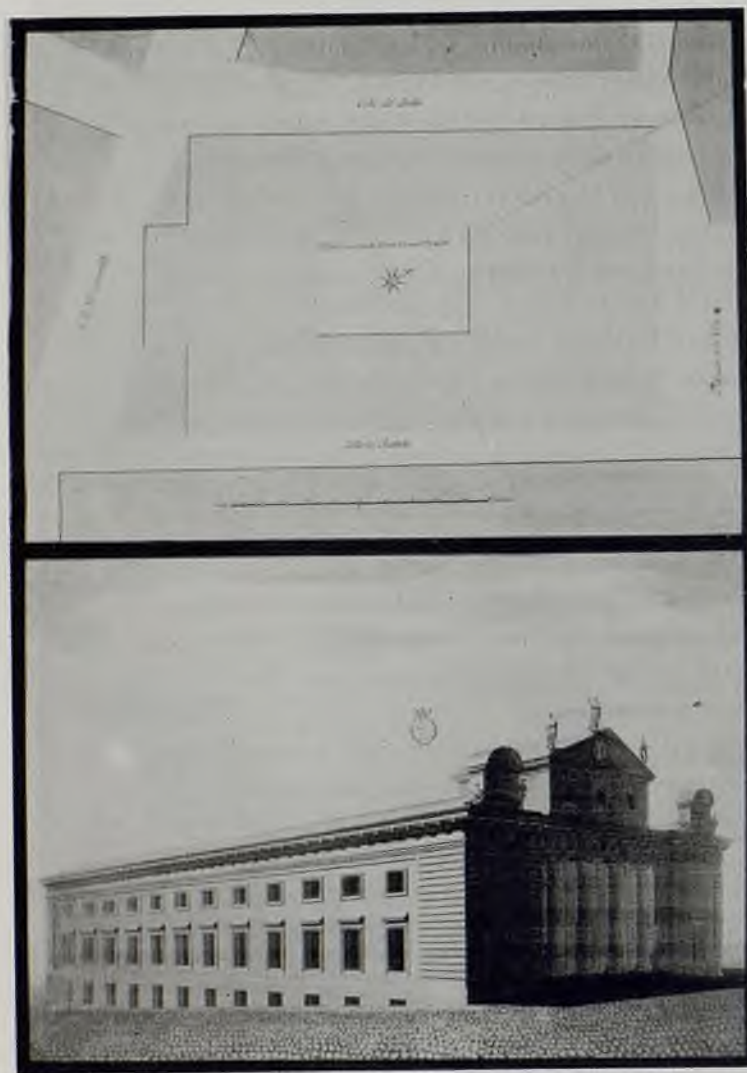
Fermín Pilar Díez, *Planta y alzado del proyecto para una Sala de Audiencia en Madrid, 1802.
